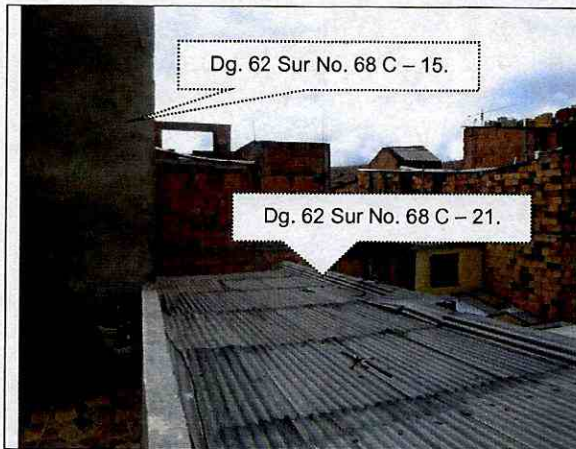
Vista de muro y placa de entepiso interior de la edificación emplazada en el predio de la Dg. 62 Sur No. 68 C - 21.
